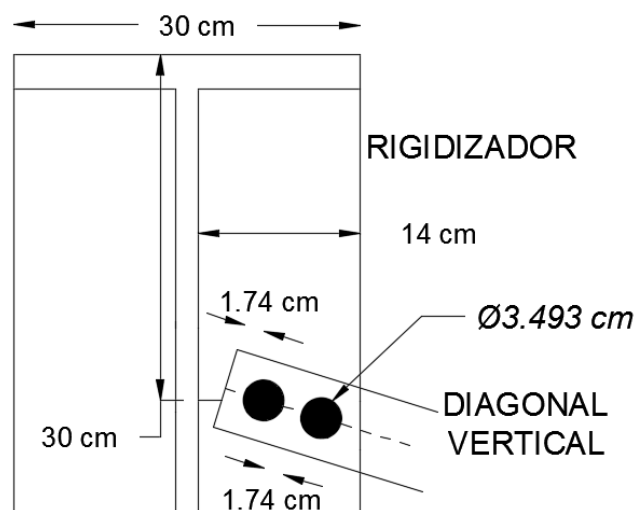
Vista conexión rigidizador transversal de apoyo e intermedio y diagonales verticales. Realizado por: Autor
